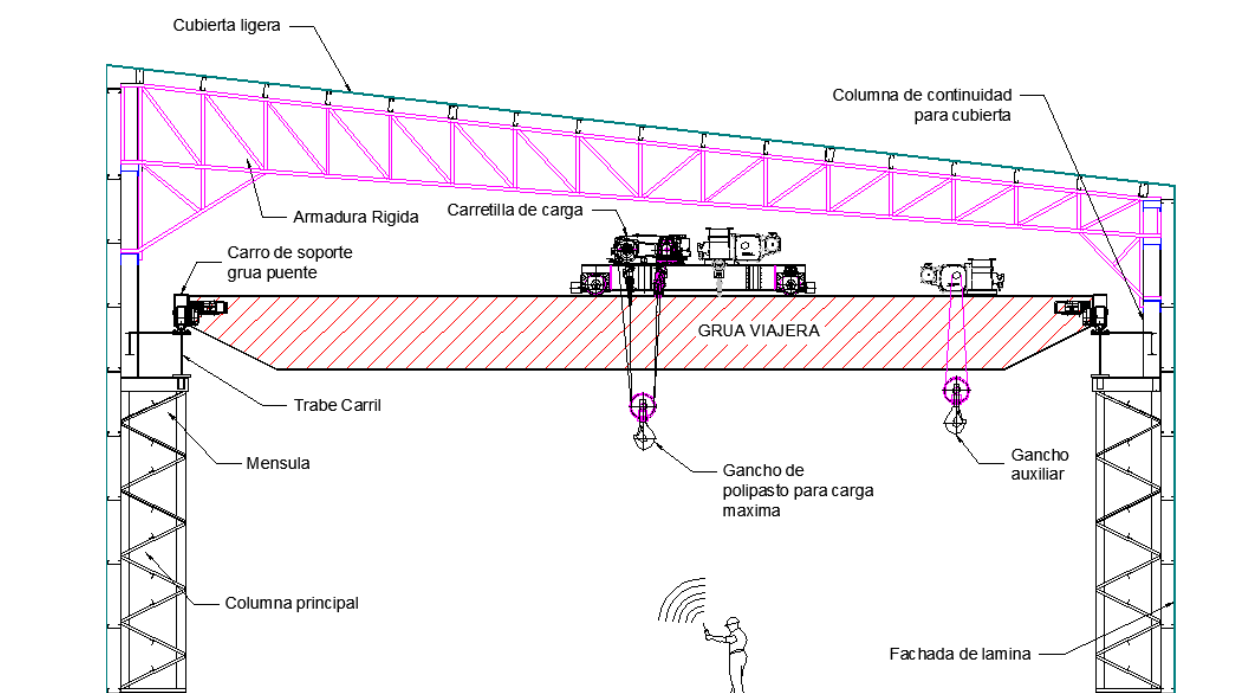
Estructura principal a base de columnas en celosía y armadura rígida a un agua para la cubierta
